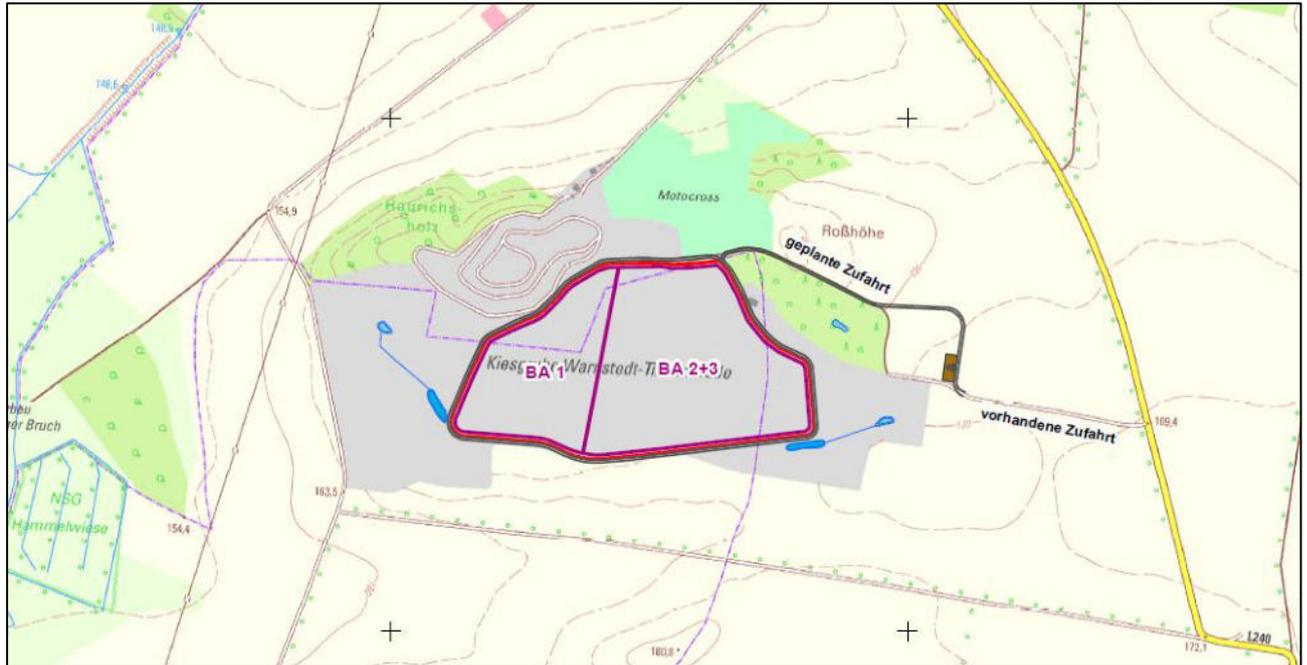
Lageplan der Deponie mit Bauabschnitten
